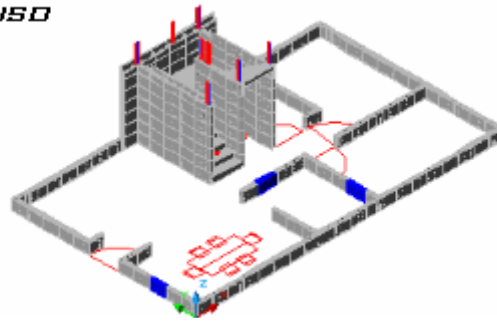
DISTRIBUCIÓN ARQUITECTÓNICA, EN PLANTA COINCIDENTE EN LOS MUROS PRINCIPALES PARA HACERLOS CONTINUOS EN AMBOS PISO
